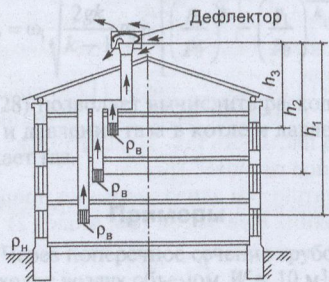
Схема вытяжной естественной канальной вентиляции
